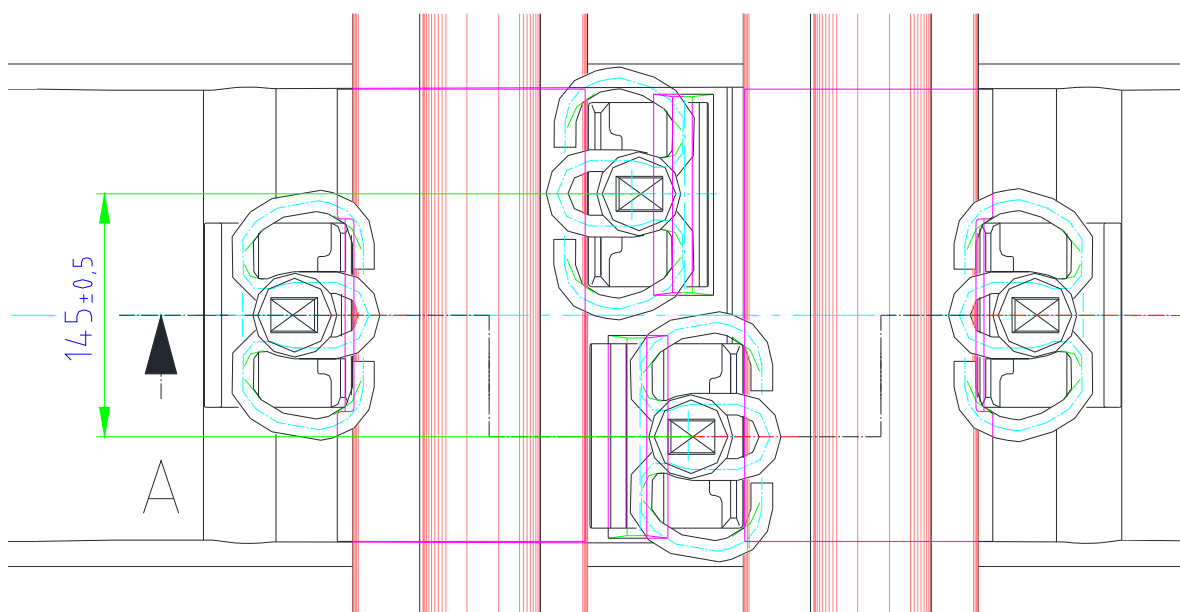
Posicionamento das fixações em travessas para 3 carris
